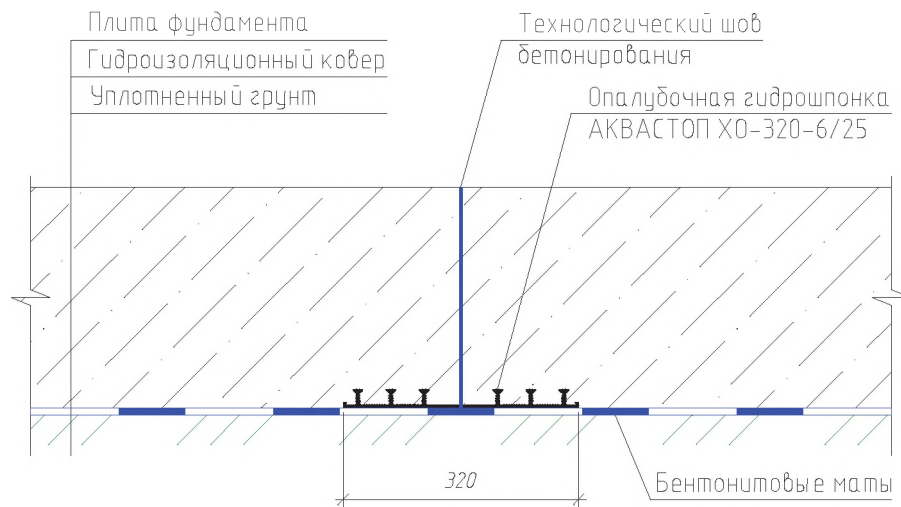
Гидроизоляция технологического шва бетонирования (вариант 1)
